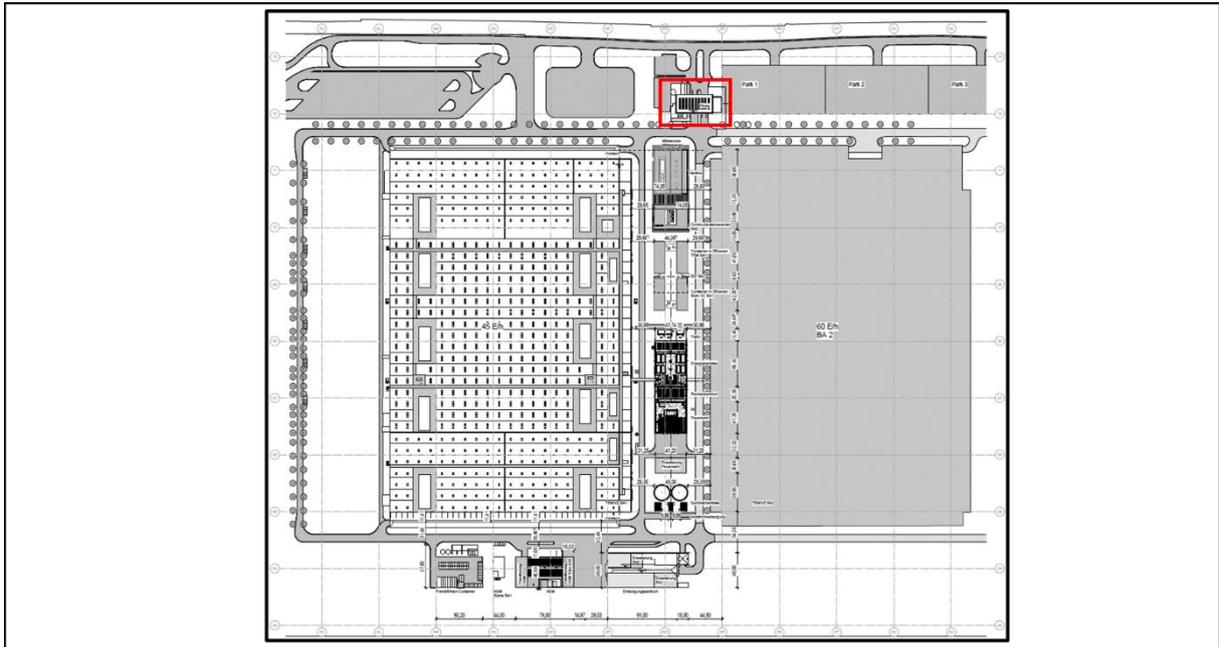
Pfortengebäude Lageplan Dachaufsicht
